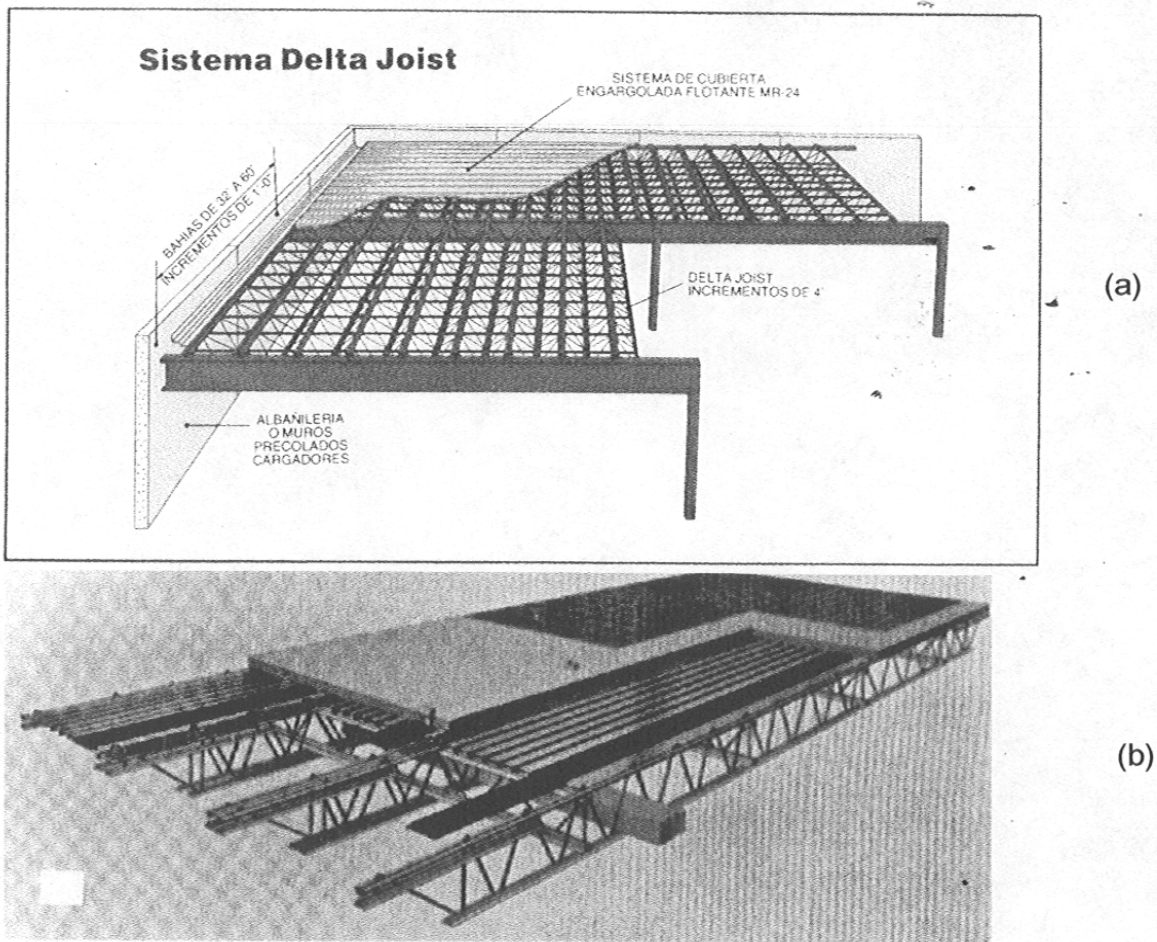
(a) Sistema de piso de concreto con deck de lámina actuando como refuerzo primario del concreto. (b) Sistema de piso con estructura de acero a base de joist laminado en frío.
